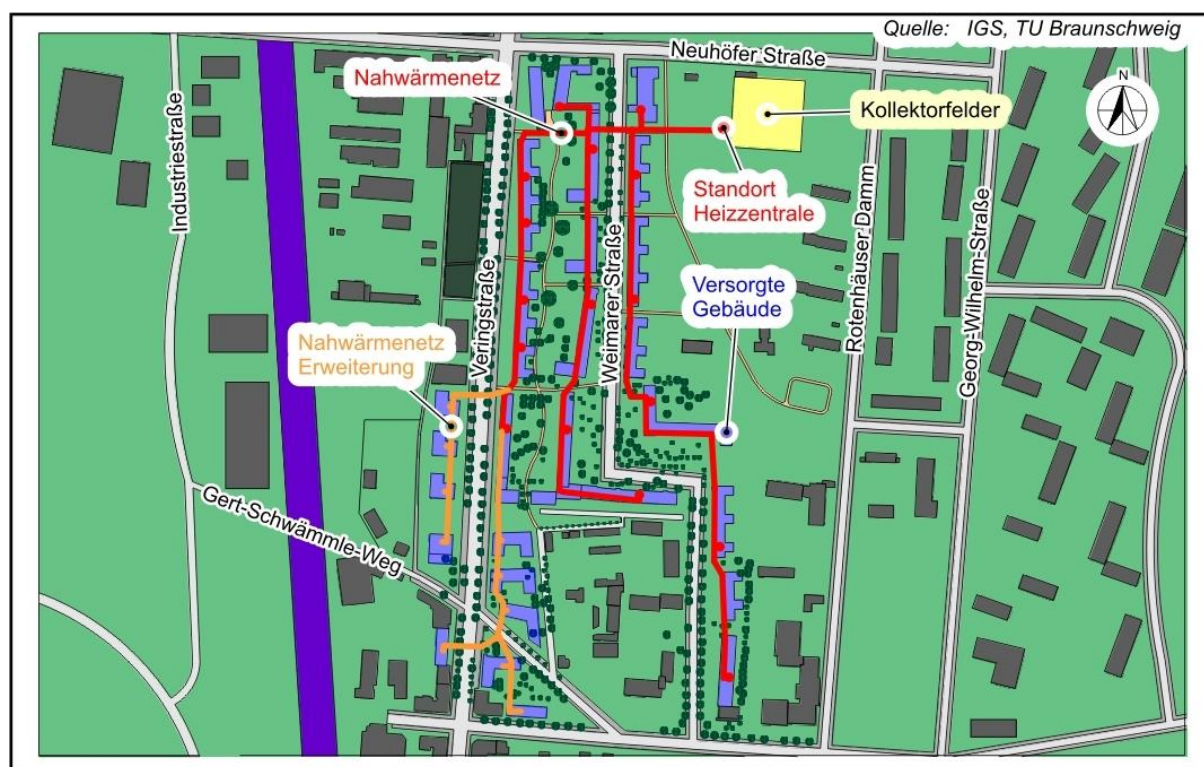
Lageplan Hamburg Wilhelmsburg, Wohngebiet Weimarer Straße
